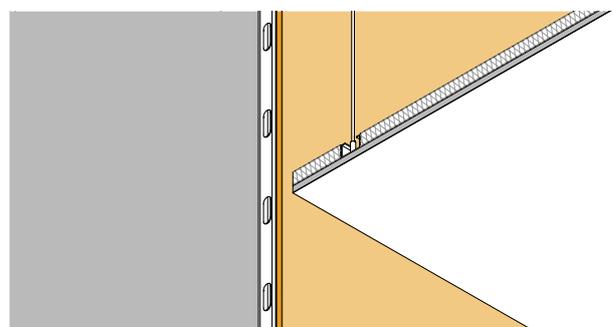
Detalle de falso techo en suspensión aplicado posteriormente
